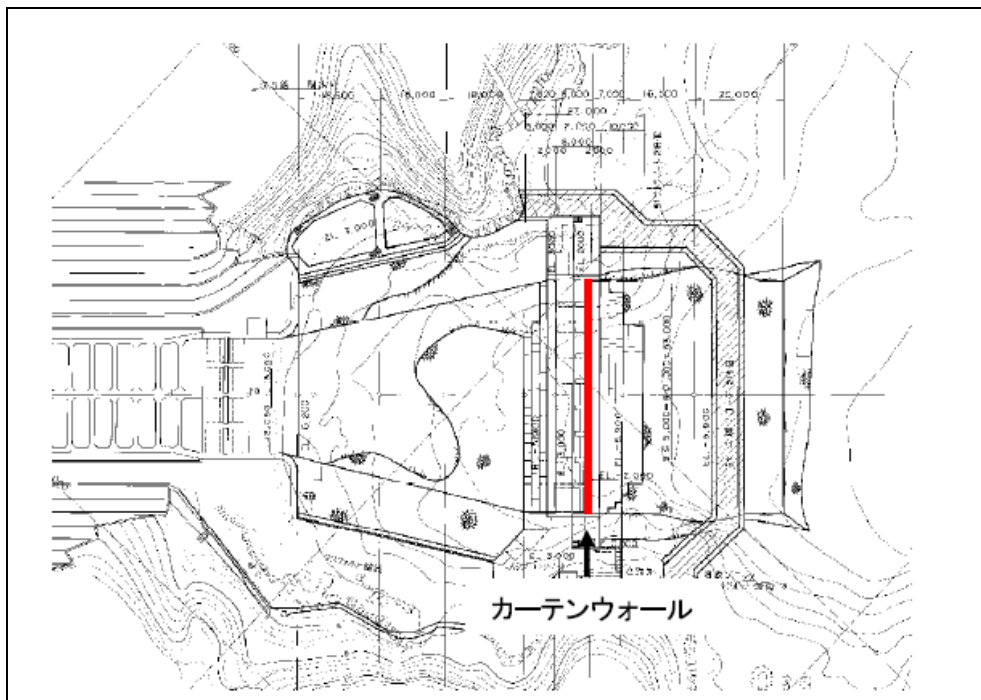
取水口カーテンウォール平面図 (関西電力 高浜 1, 2 号炉)
